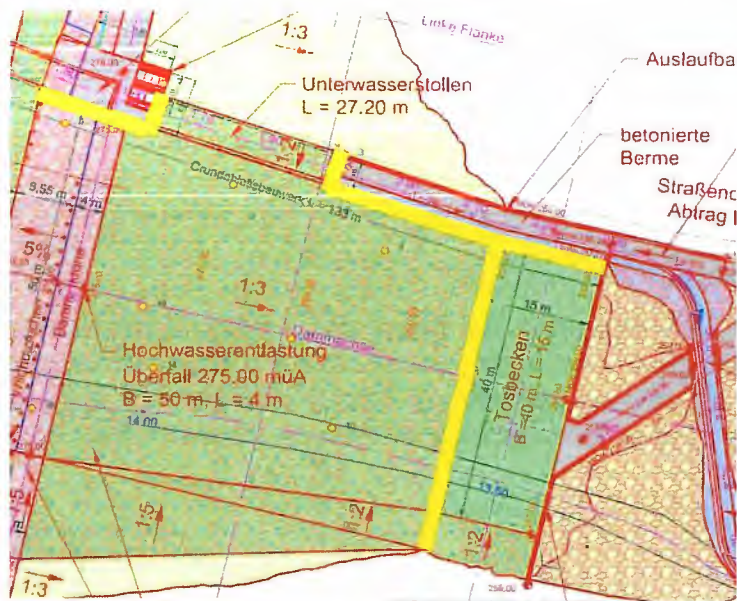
Bewegungsfugen m. Dichtung, HW-Entlastung, Tosbecken (gelbe Linien); aus Bericht Vorbemessung
